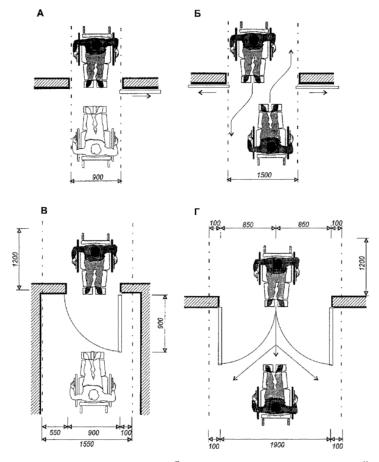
Размеры дверного проема для свободного проезда инвалидной коляски (А-Г)
